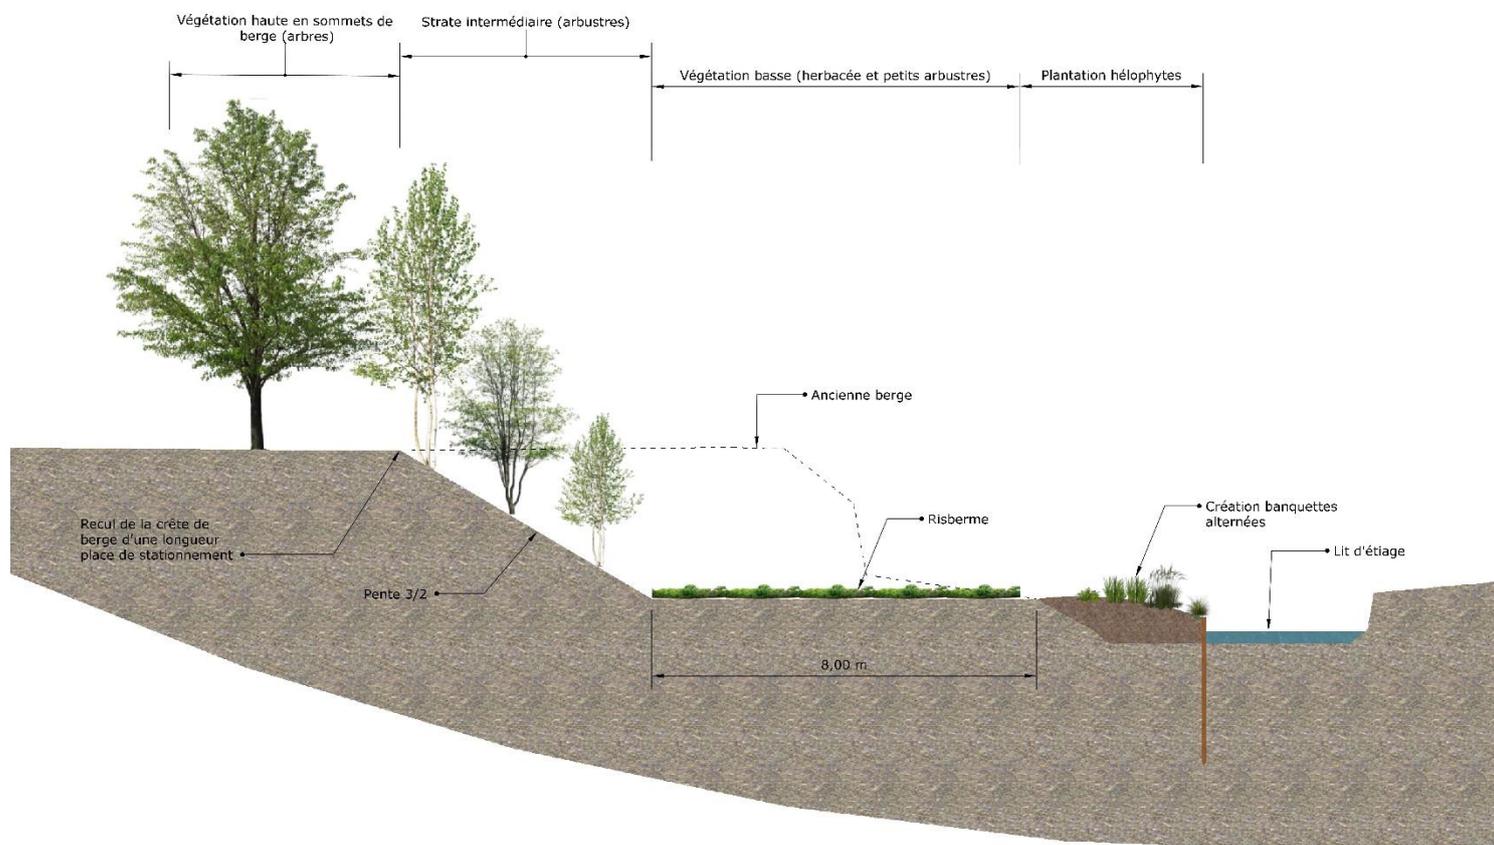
Coupe en travers type au niveau du parking – Profil 131
